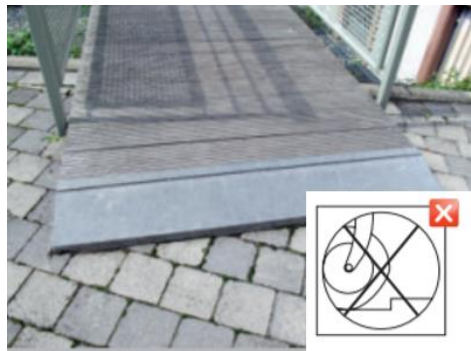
Ressaut au départ d'une voie d'accès, Source : Guide pour la construction d'un bâtiment accessible
